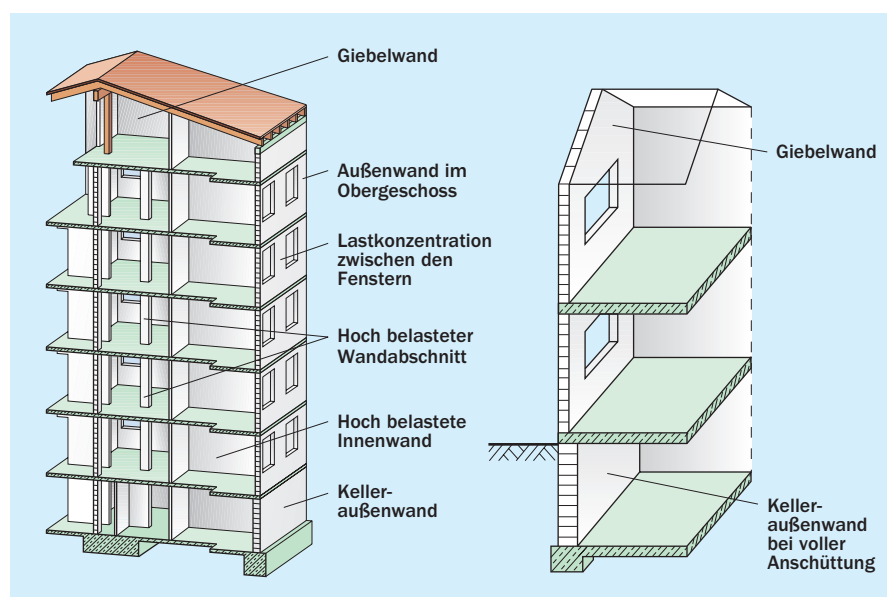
Wichtige Bauteile und wesentliche Nachweisstellen im Mauerwerksbau
